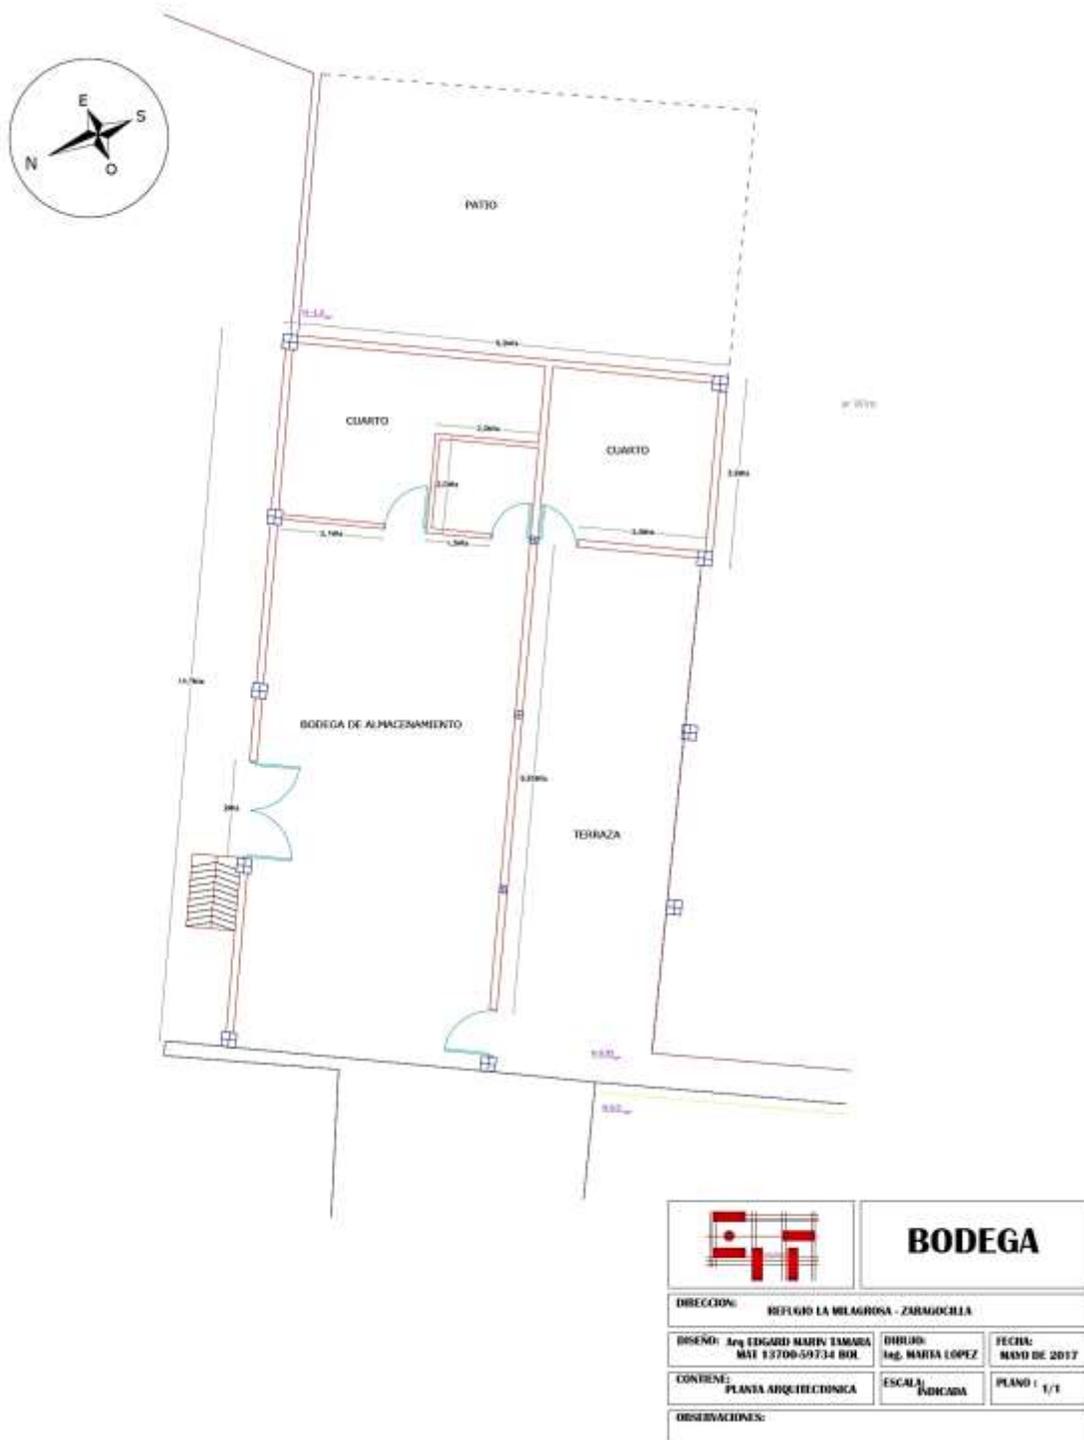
Plano - planta de la bodega "Refugio la Milagrosa" (modelo CAD). Fuente: Firma Edgard Marín
